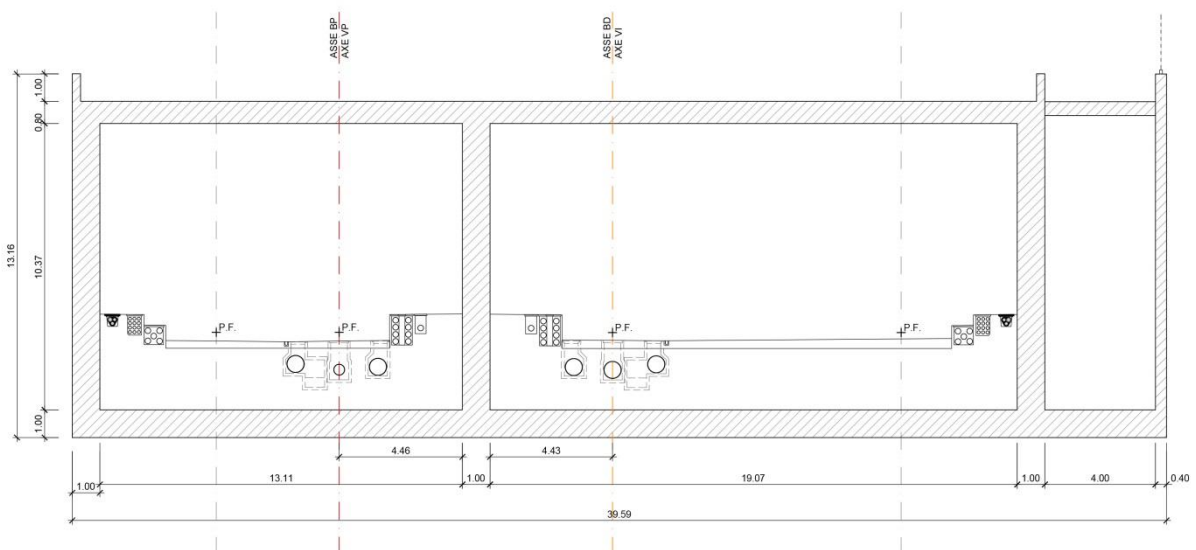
Sezione tipo galleria artificiale BP pk 61+116.52 – 61+196
